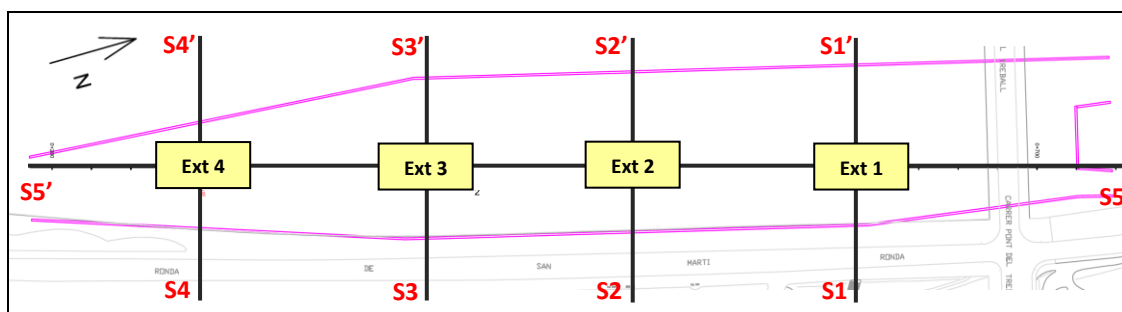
Perfiles transversales situados en cada uno de los extensómetros instalados.
